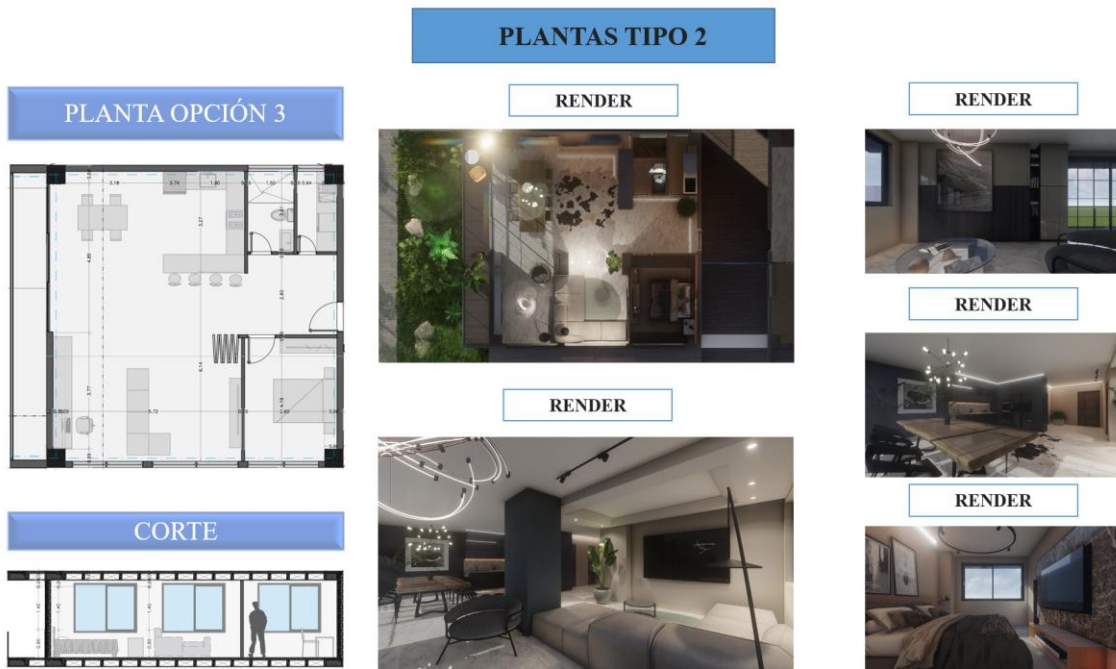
Plantas y cortes vivienda tipo 2 – Zonificación
